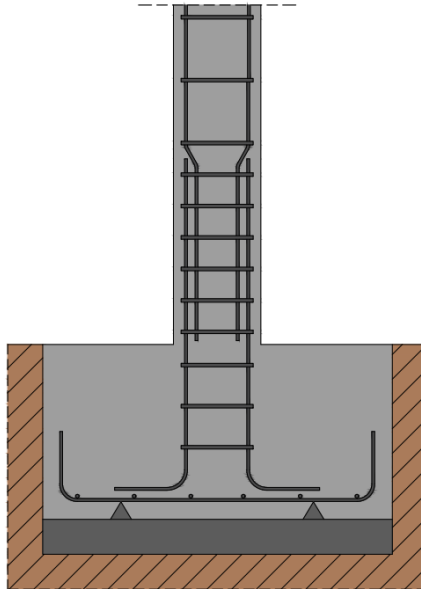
Detalle zapara aislada y pilar. 2024. Fuente: Propia
